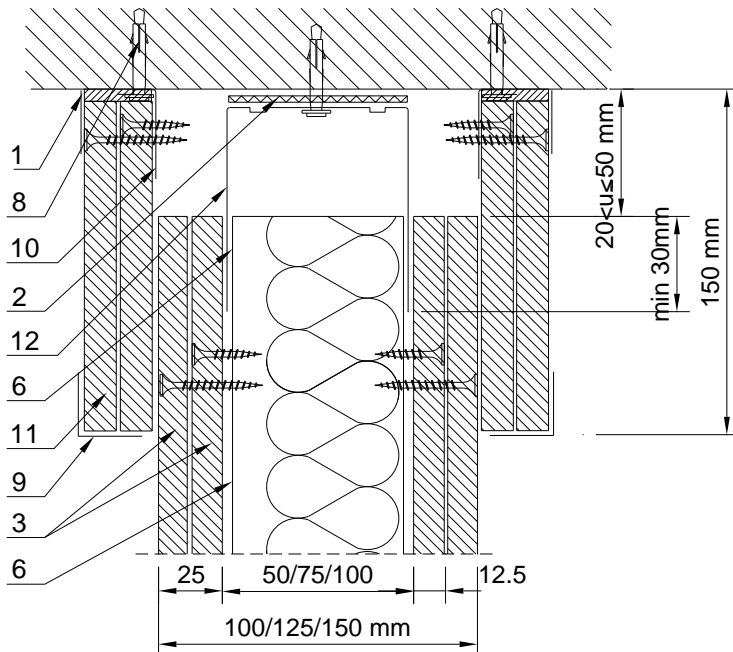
Schemat wykonywania połączenia ściany ze stropem – kompensacja ugięcia
